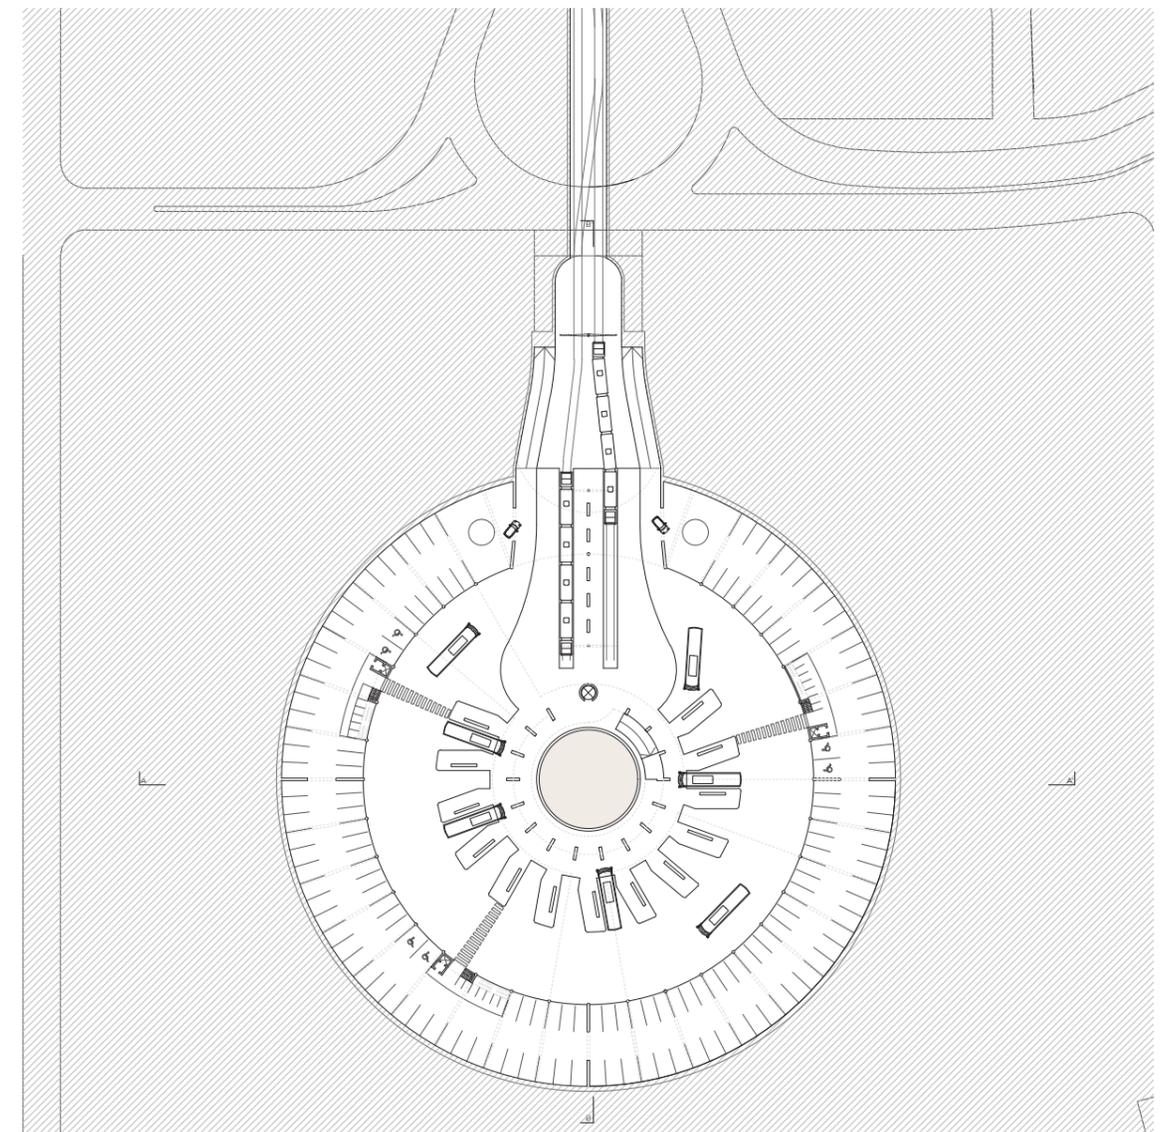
PLANTA P-1 REDUÇÃO DA ESCALA 1:1000
